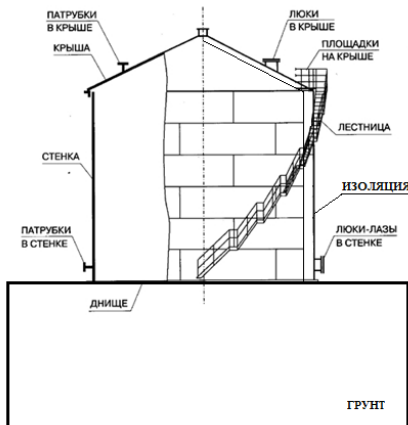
Схема наземного вертикального стального цилиндрического резервуара
